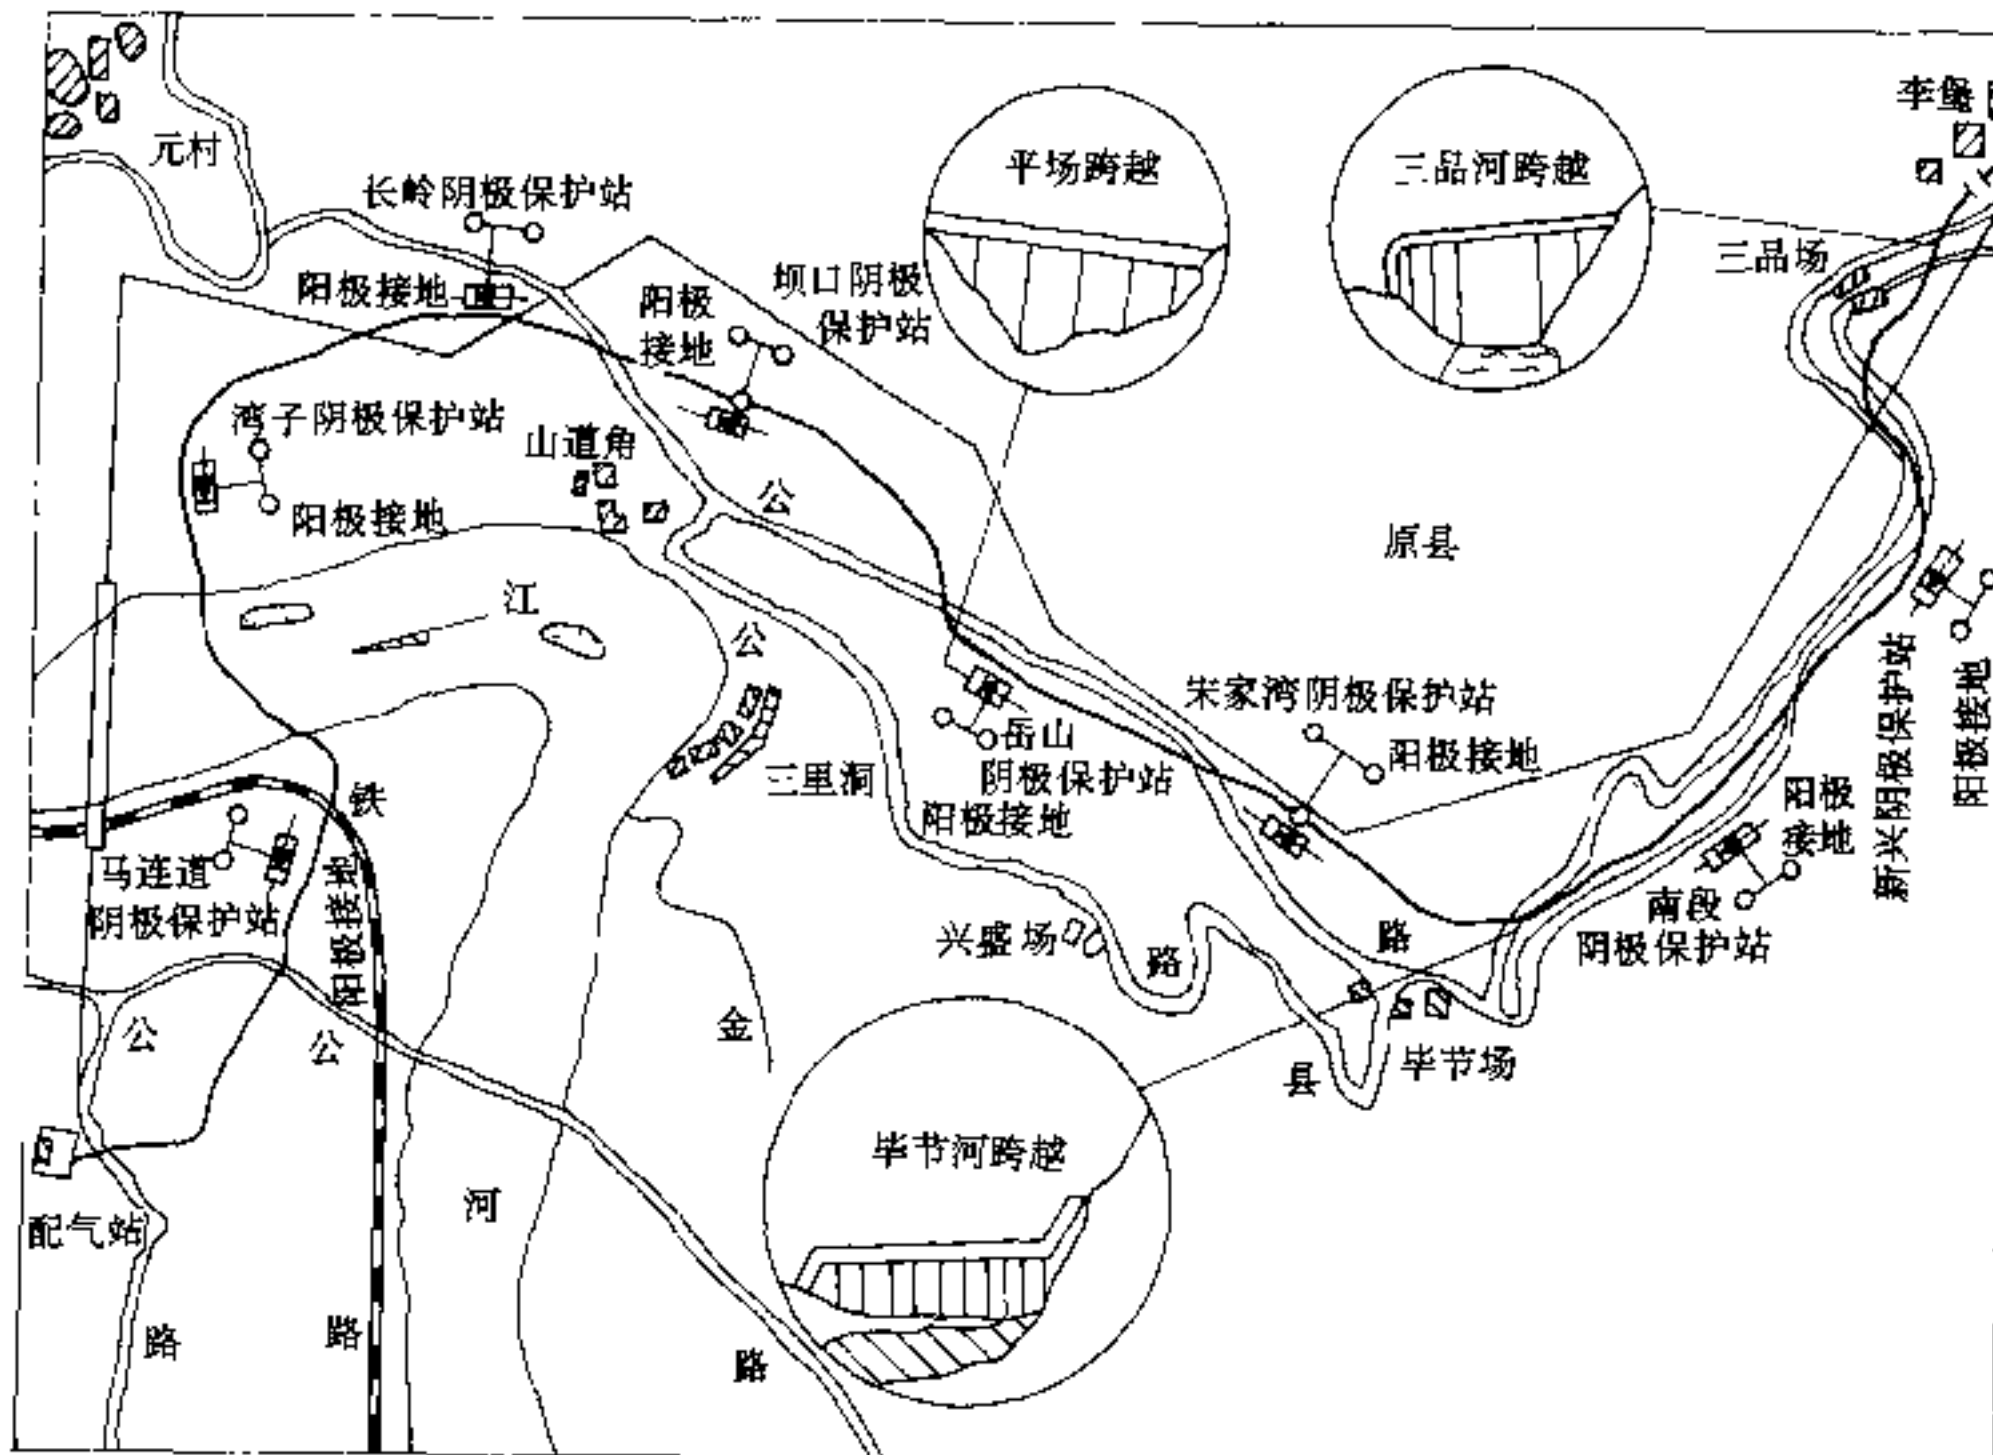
输气管阴极保护站平面布置示意图 (参见图 34-67)
